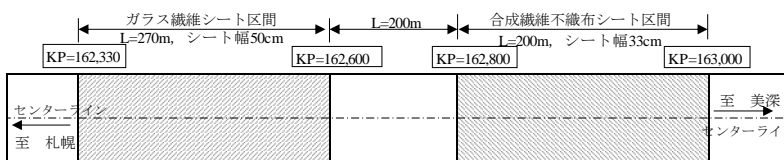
低温ひび割れ補修箇所の平面図
